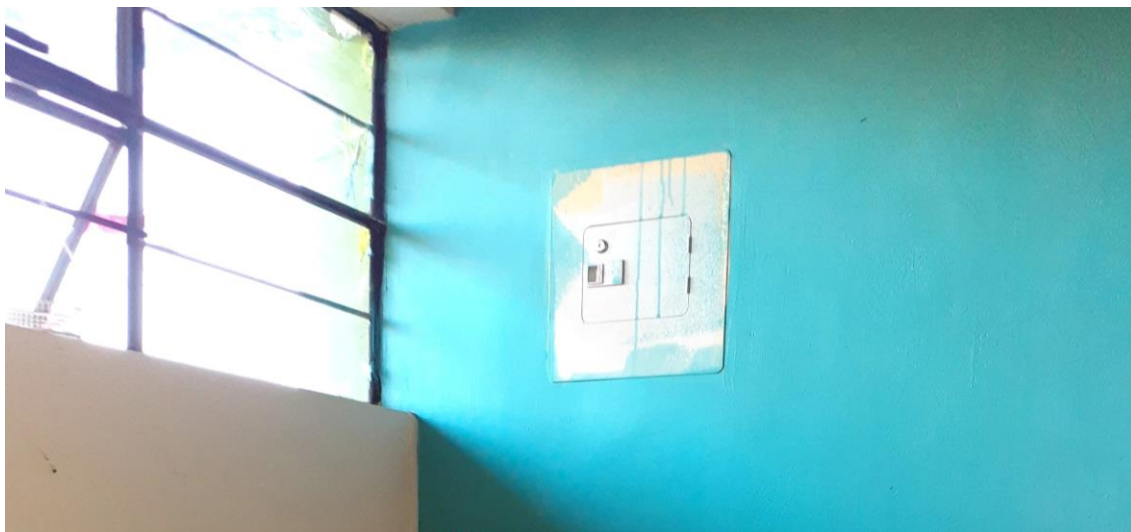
Imagen corresponde al interior de la dirección (Pabellón II). El cableado eléctrico está empotrado en piso y techos. El pabellón cuenta con su propia caja de distribución eléctrica conectada al medidor.
